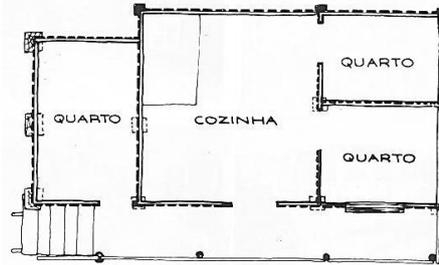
Planta tipo da casa de pescadores da região Centro-Litoral.
